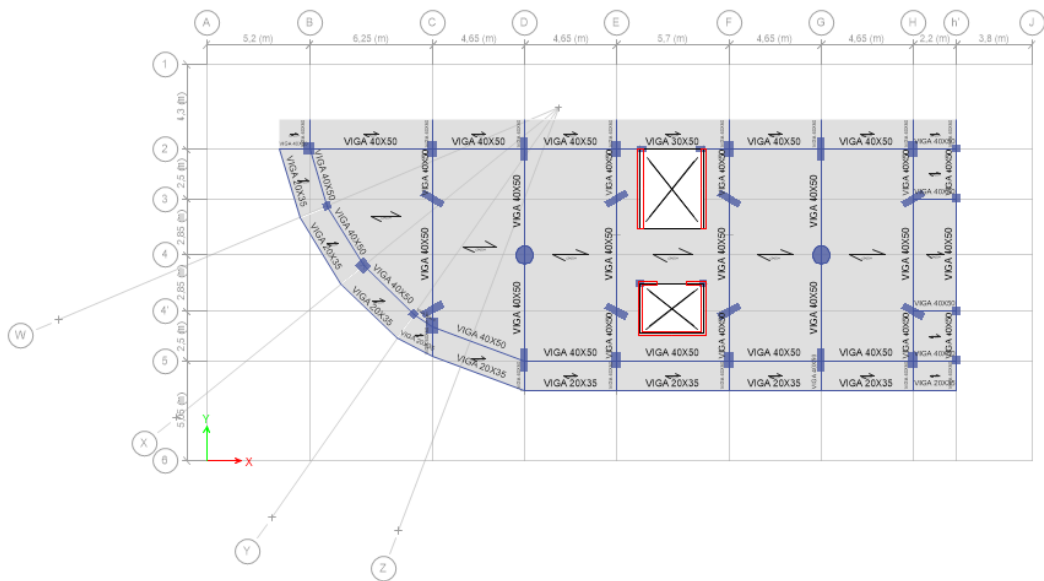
Planta nivel +7.20 m Edificio Silva Núñez
